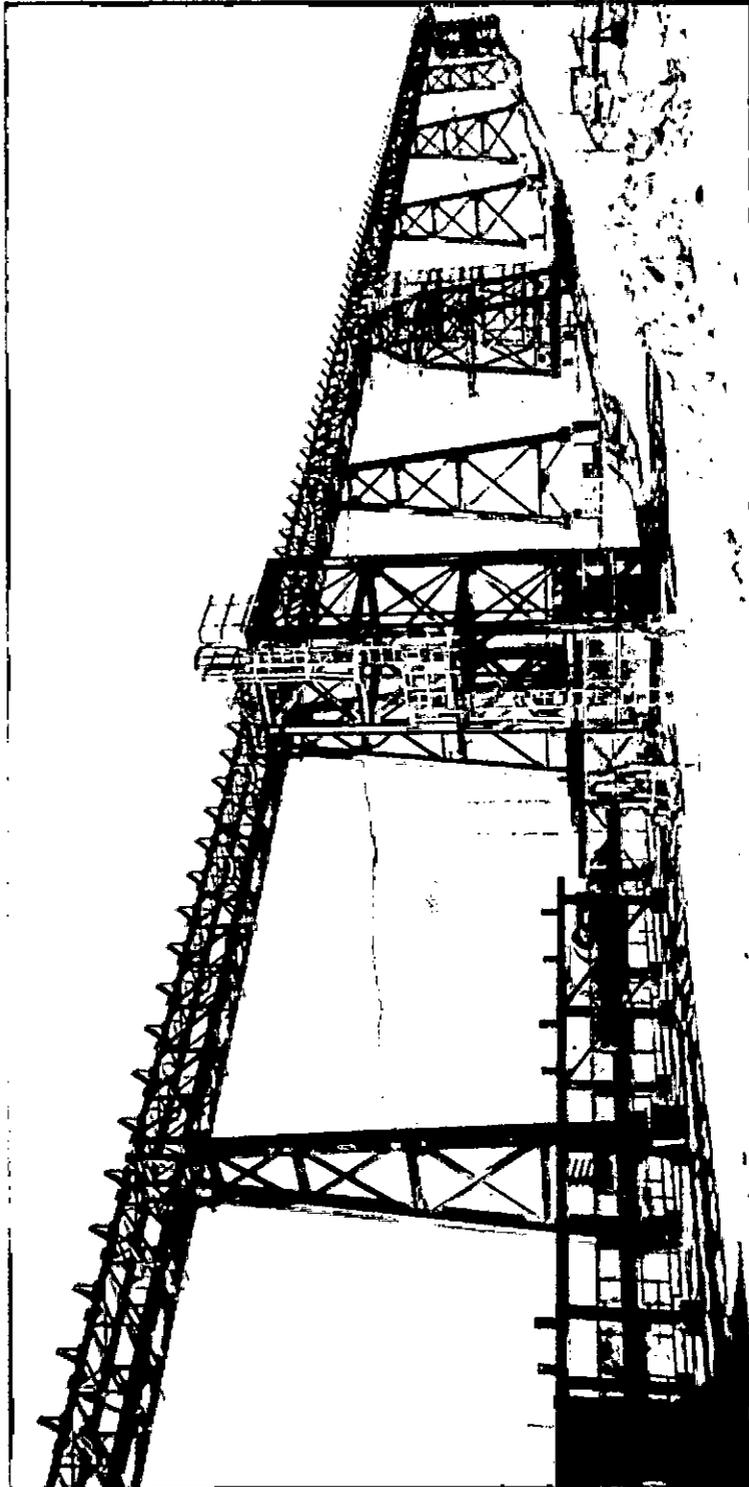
VISTA DE ELEVACION DE LA TORRE DE CONTRAPESO Y CARRO
